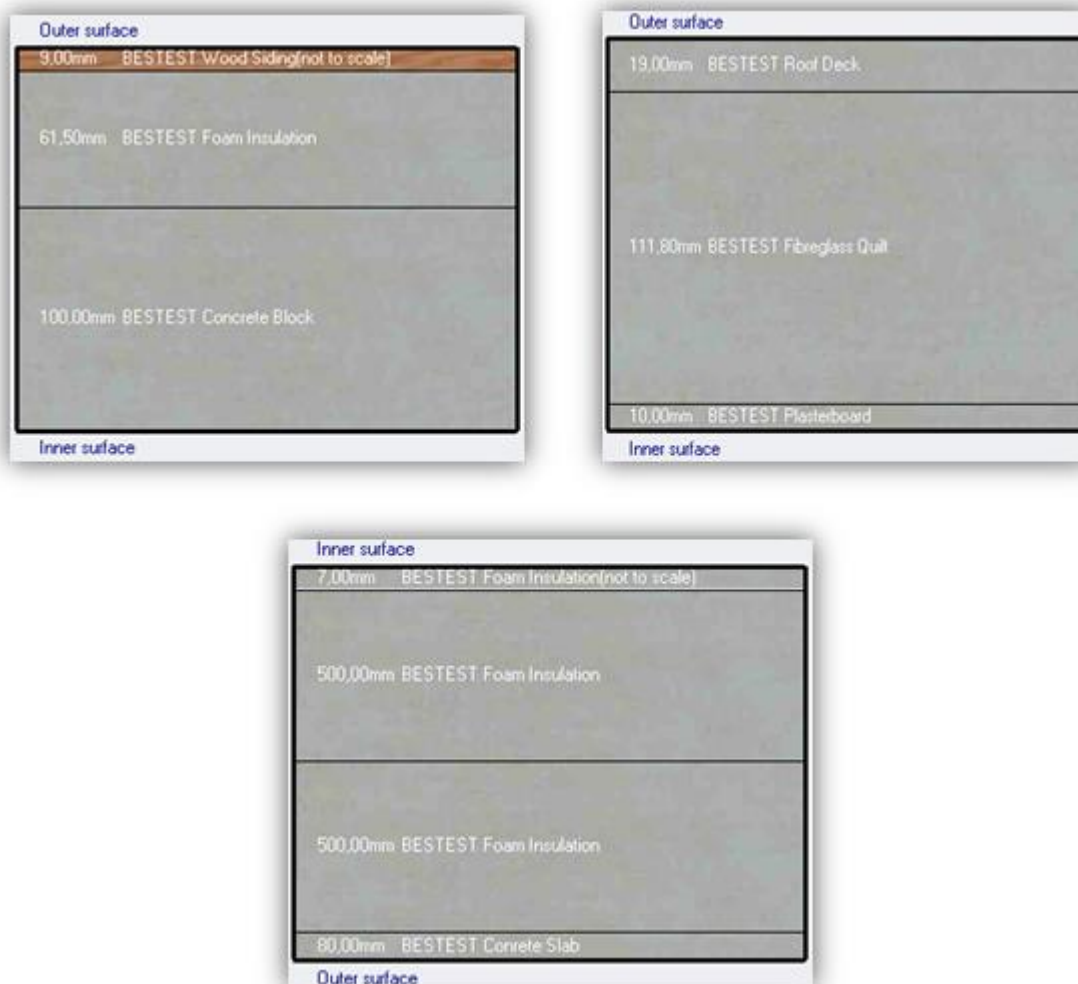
Corte transversal da parede, teto e pavimento (pela ordem de apresentação)
